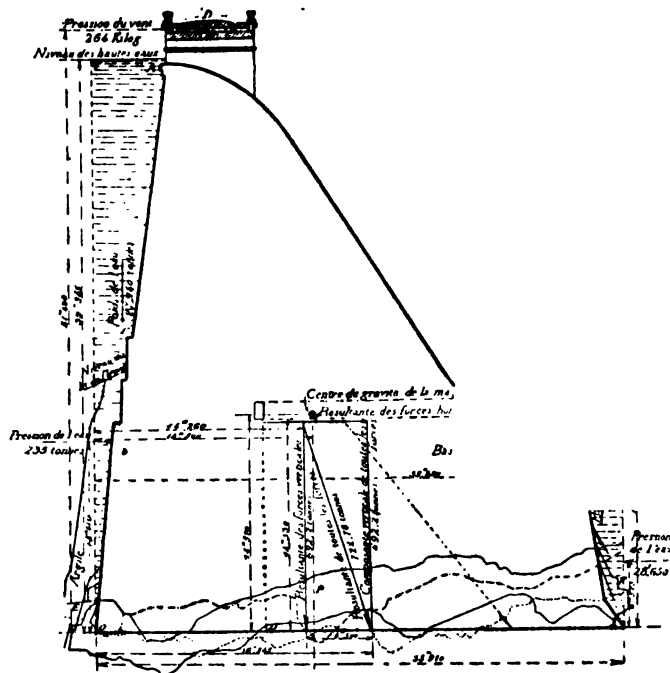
Profil du barrage du Vyrnwy (Angleterre).
